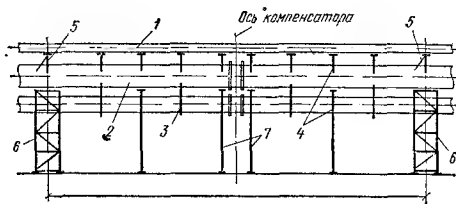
Схема трубопроводной системы балочной прокладки
